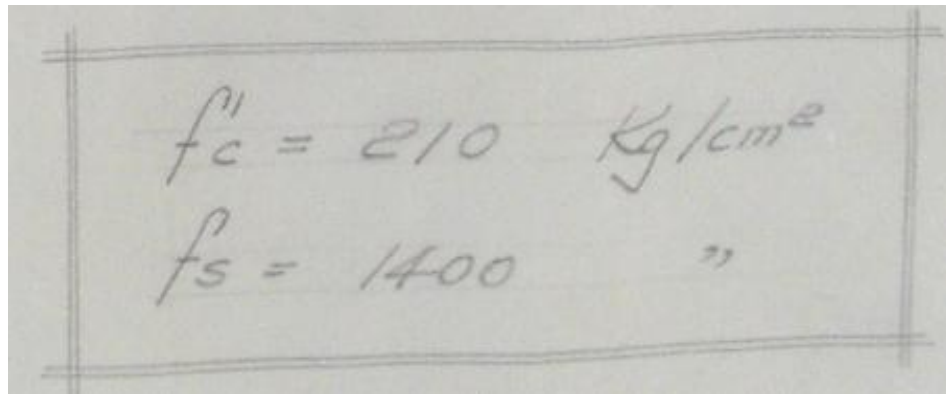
CUADRO PLANO ESTRUCTURAS
